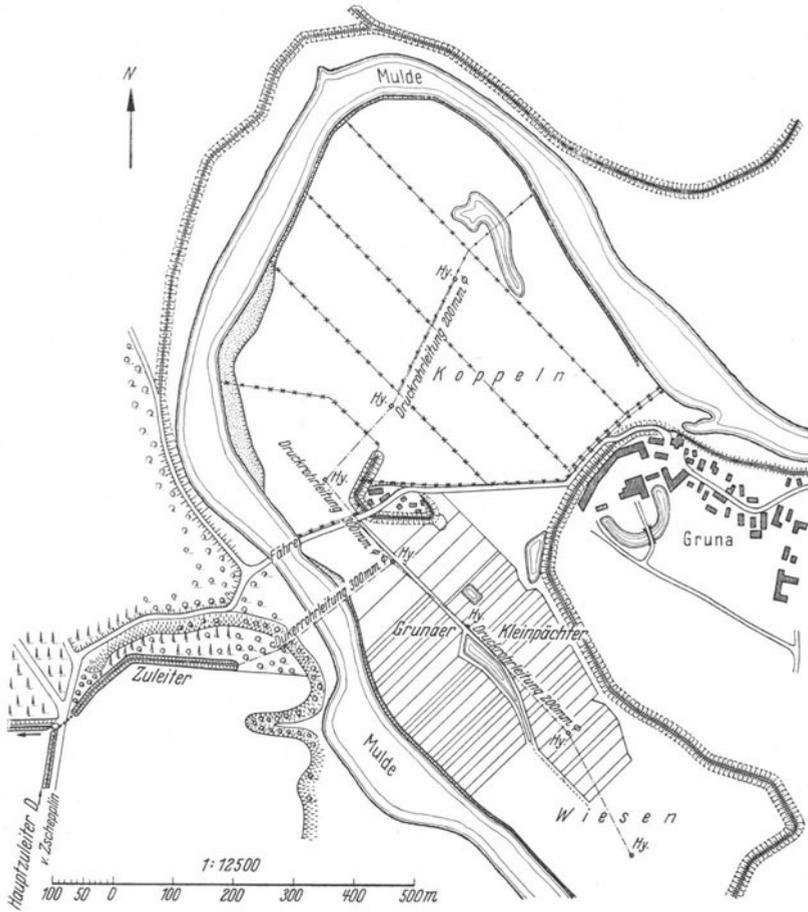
Lageplan der Naturdruckregenanlage Gruna.
